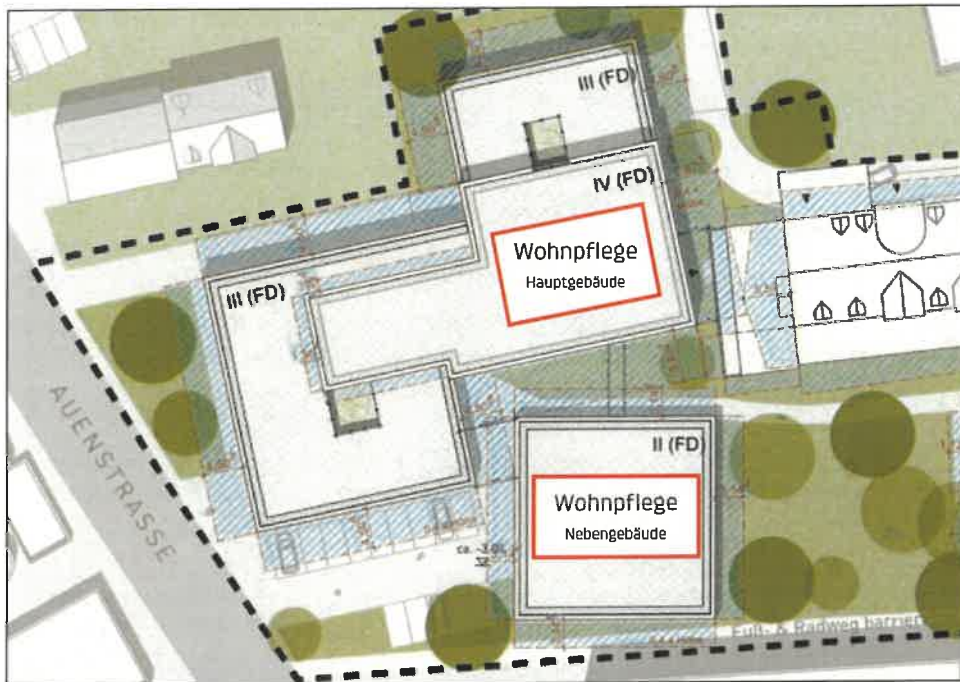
Lageplan mit Darstellung der Wohnpflegeeinrichtung
